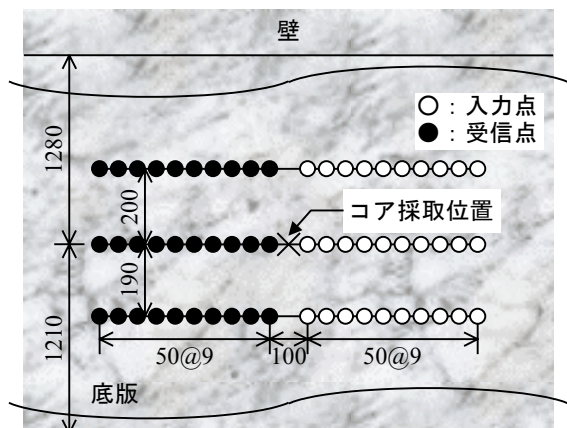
部位 No. 1 での測定位置（平面図，単位 mm）
